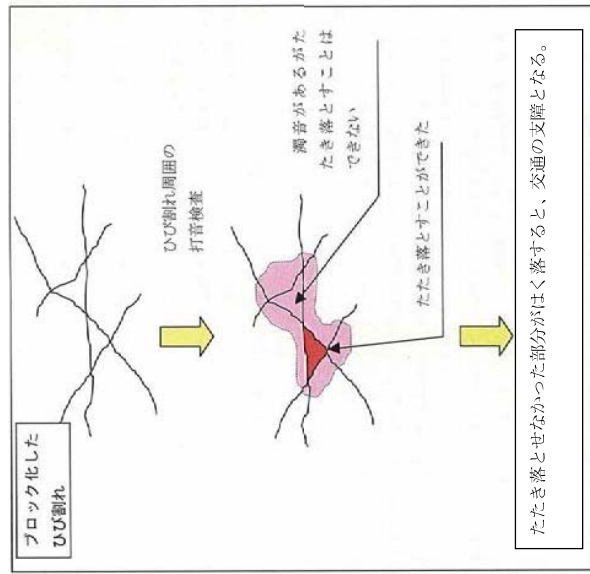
ブロック化したひび割れの例 ㊦
